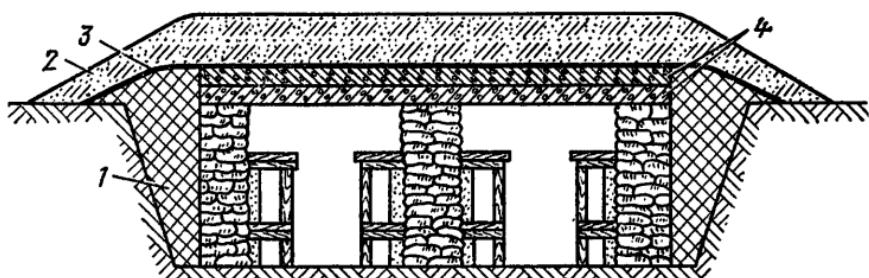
Убежище со стенами из грунтонабивных мешков:
